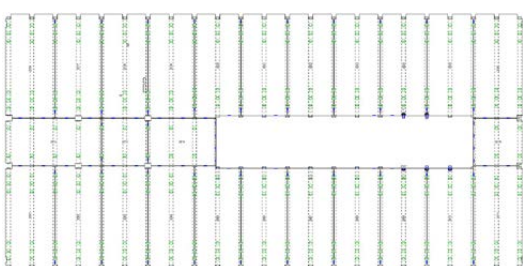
Grundriss des Referenzobjektes mit vorgefertigten Wilma Betonelementen
